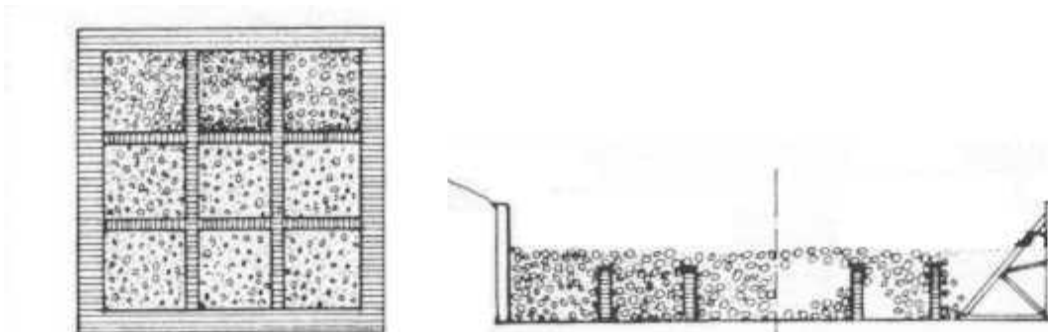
Planta e corte transversal de “caixa” de fundação contínua [Piccirilli, 1996].
